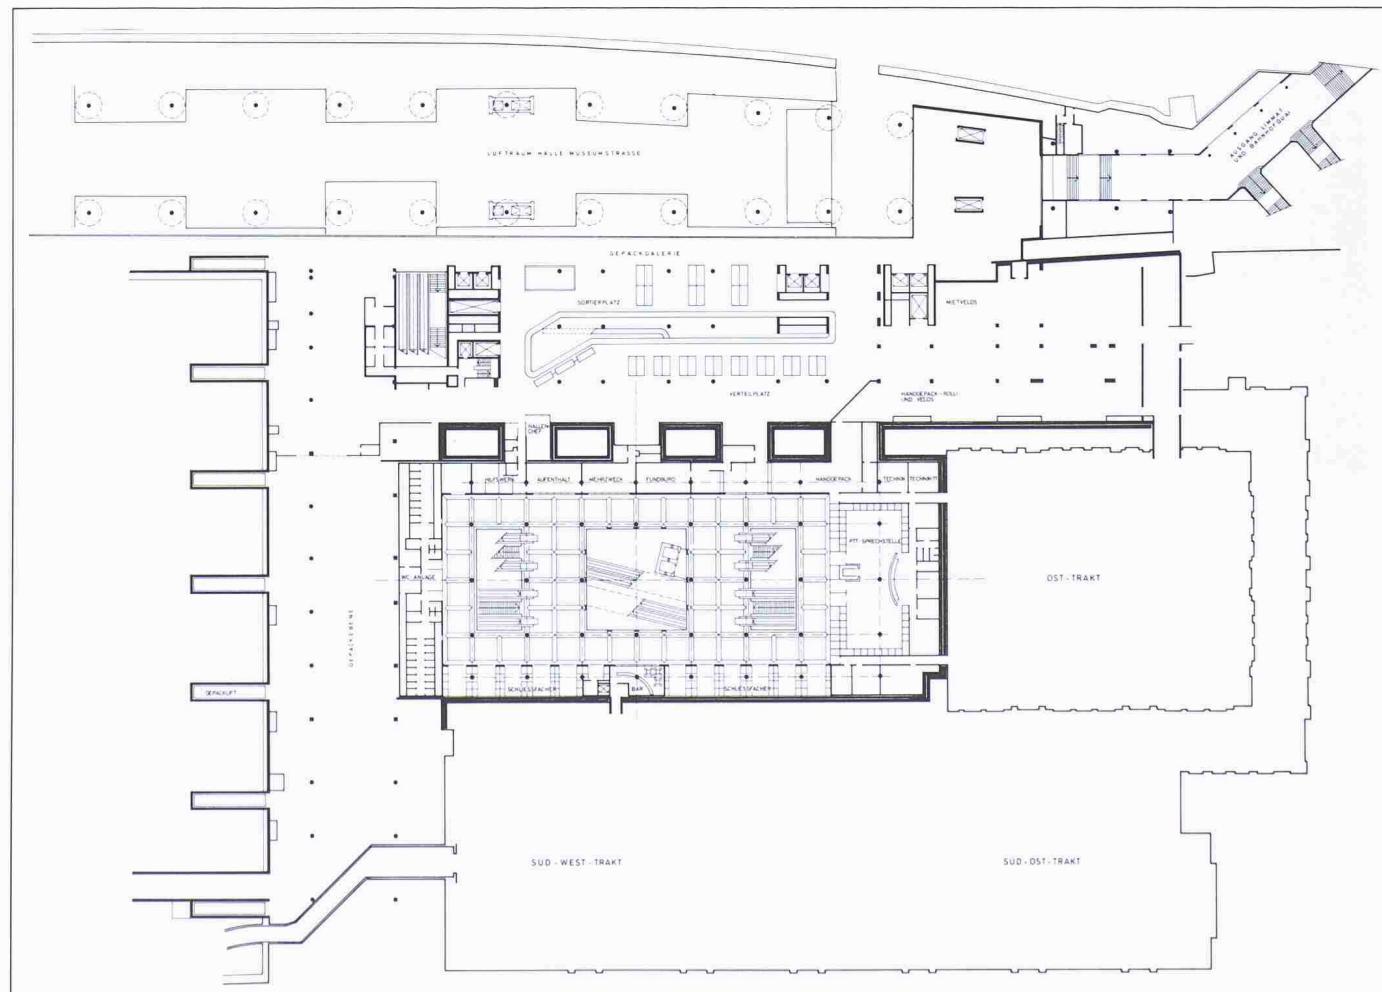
Grundriss Dienstleistungsebene (minus 1)
